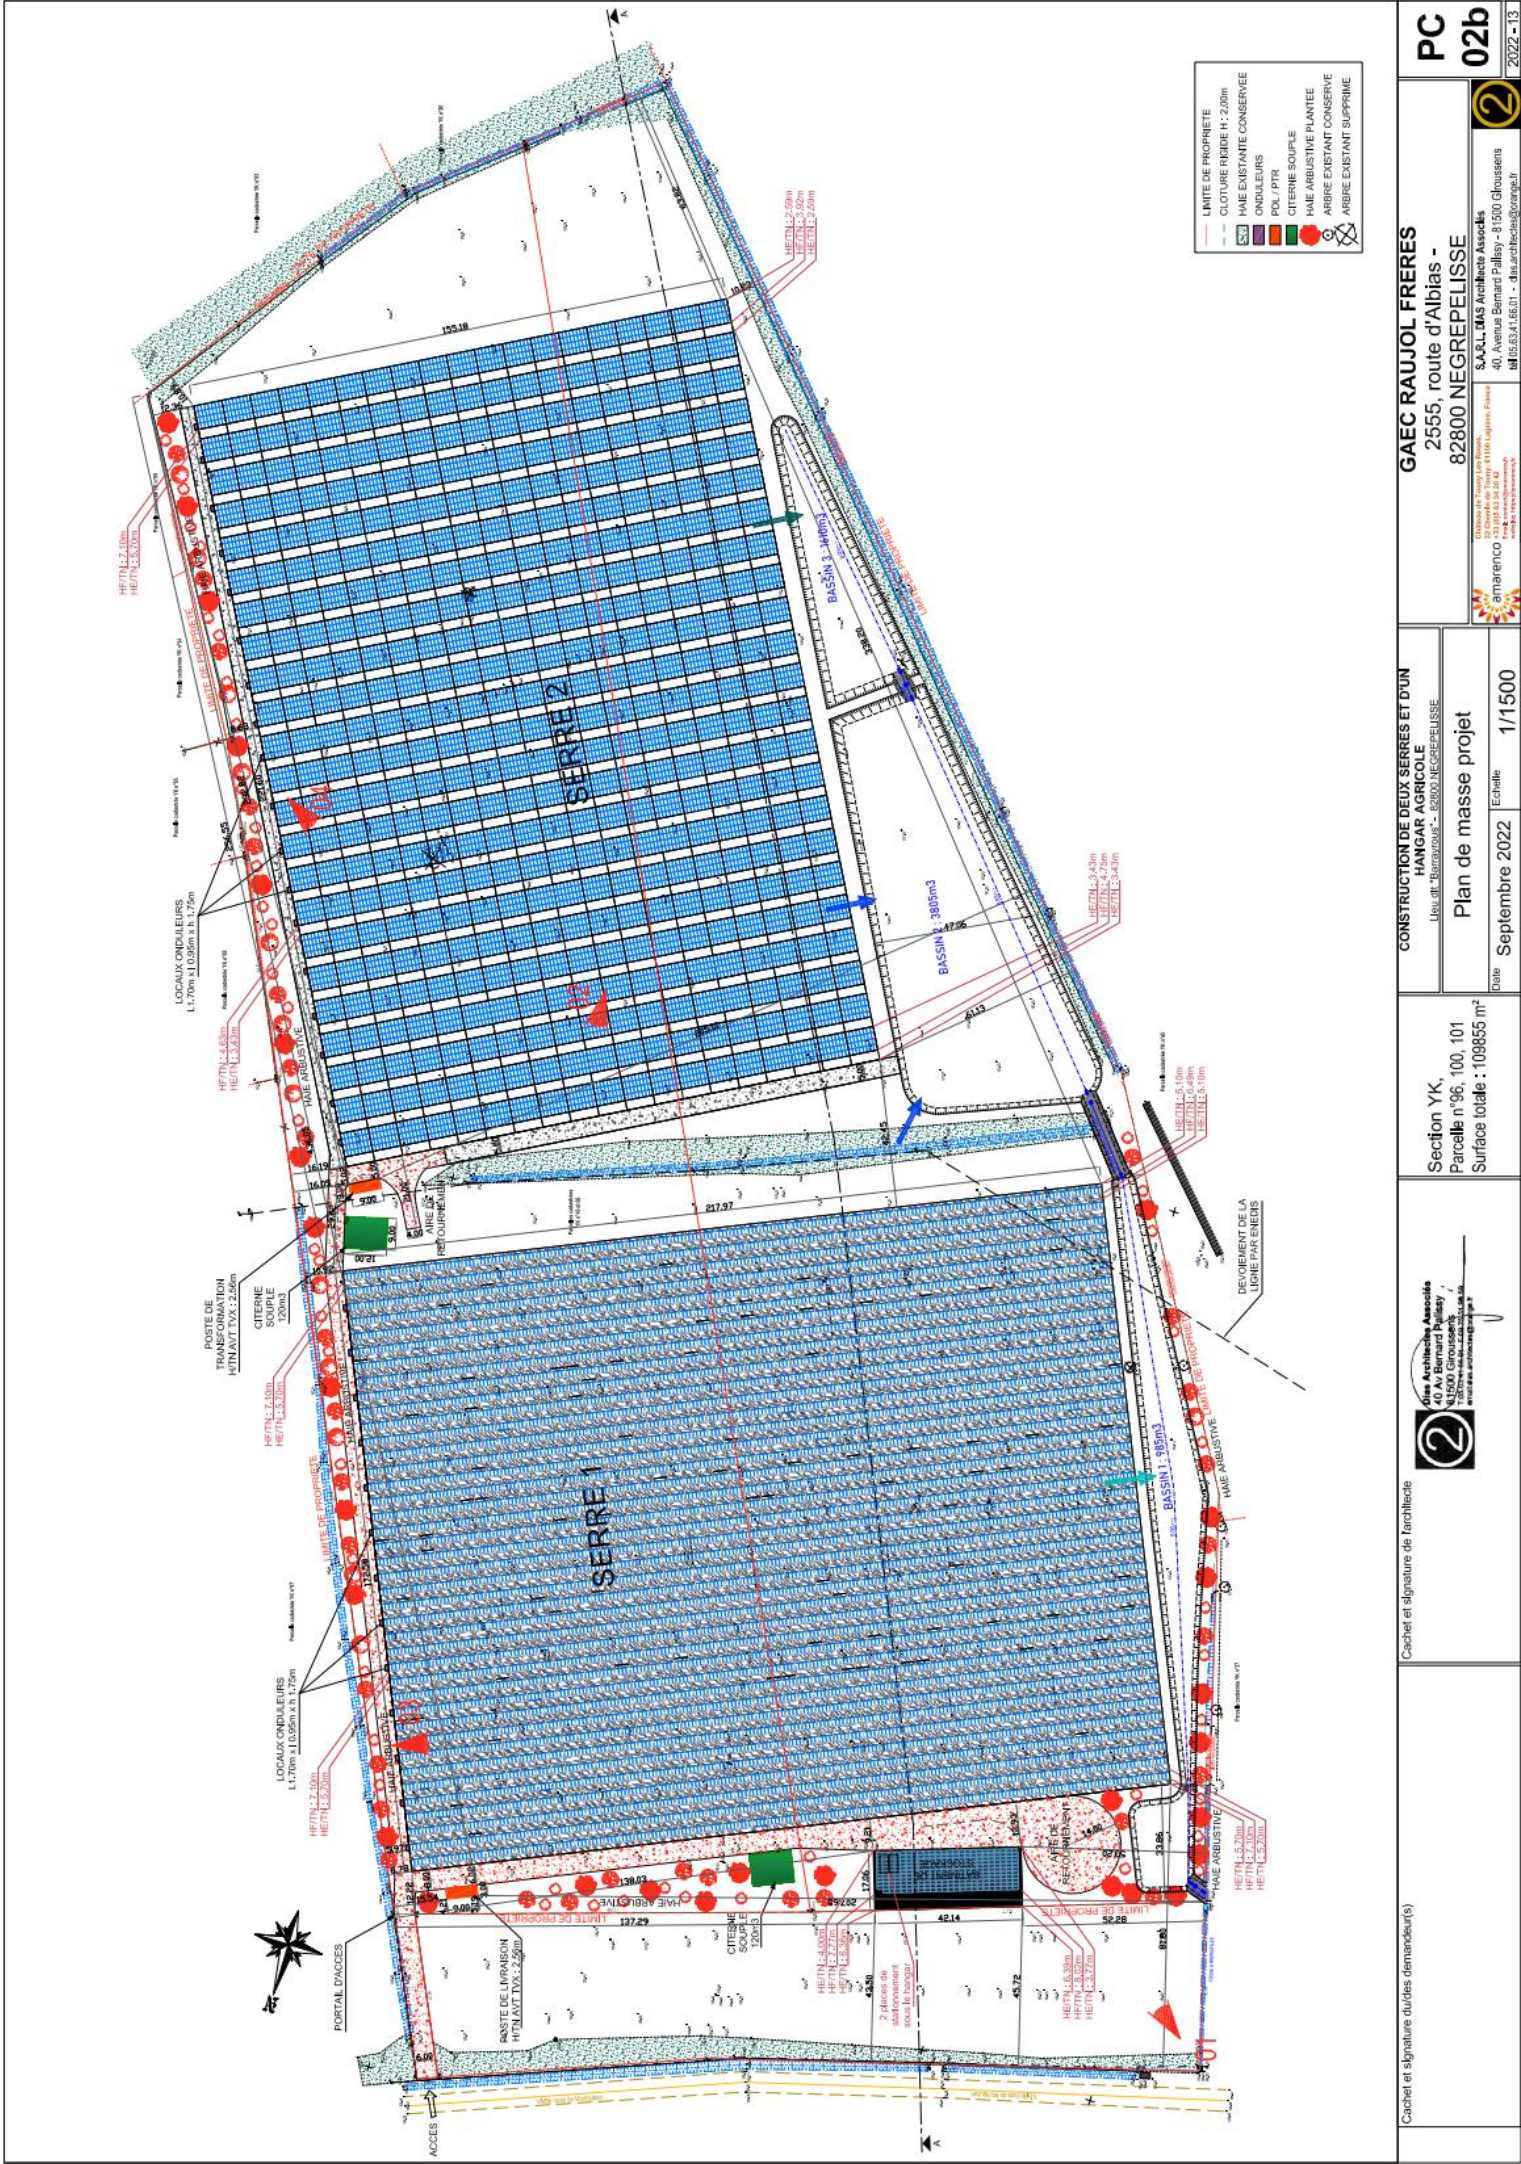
Plan d'implantation de la variante finale – Source : Amarenco
